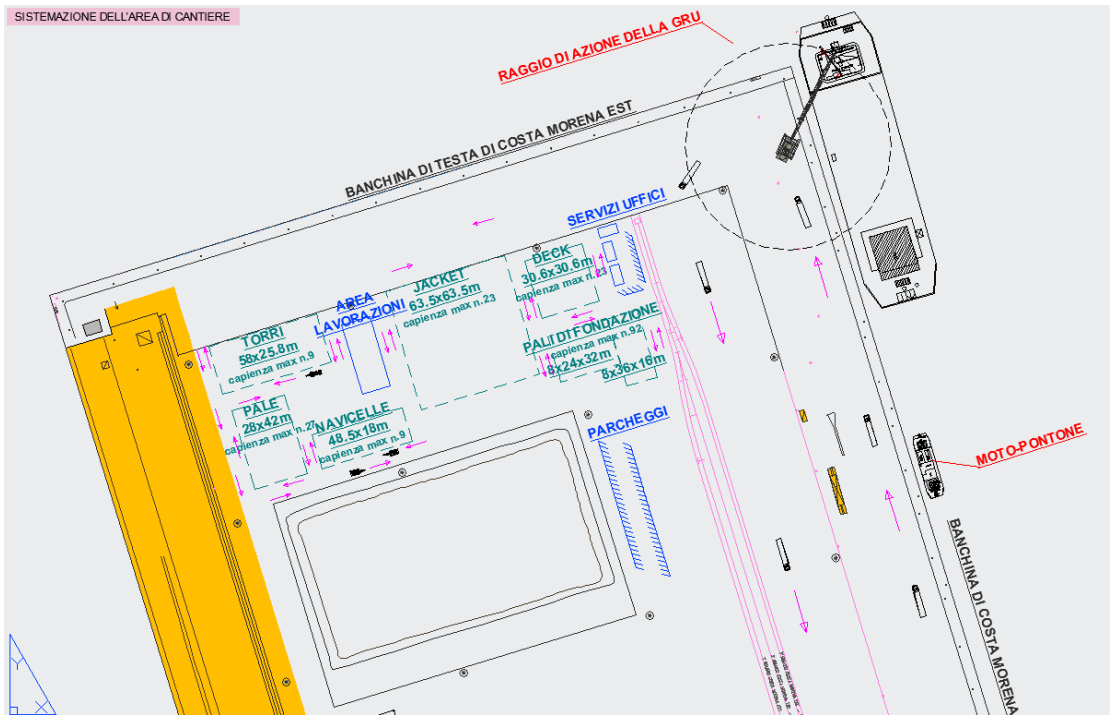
Layout di cantiere a terra nel porto di Brindisi.
